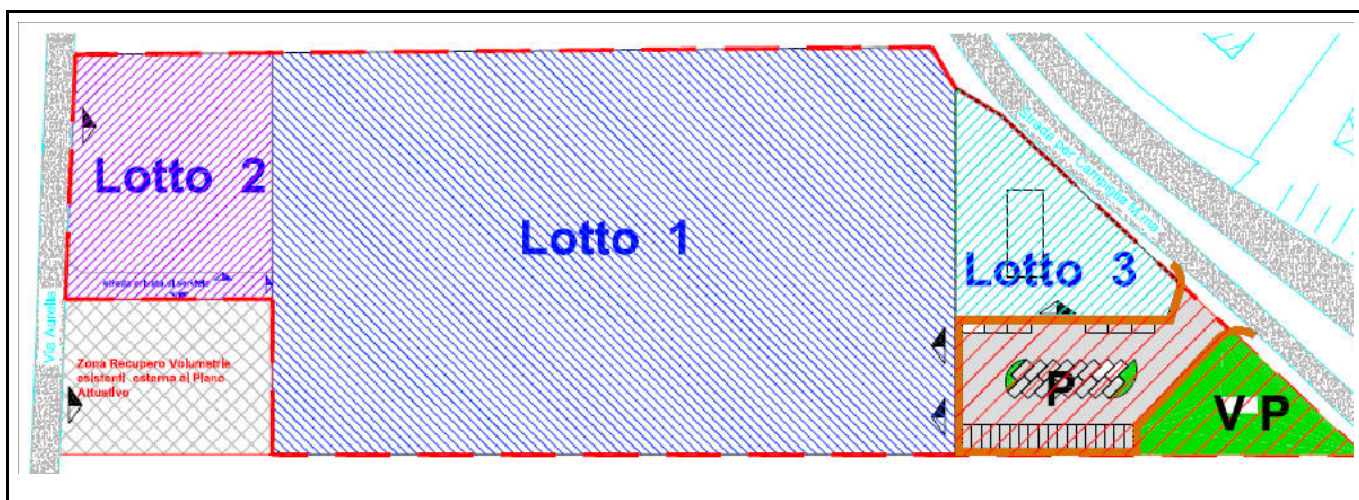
Planimetria generale degli interventi previsti dal Piano
